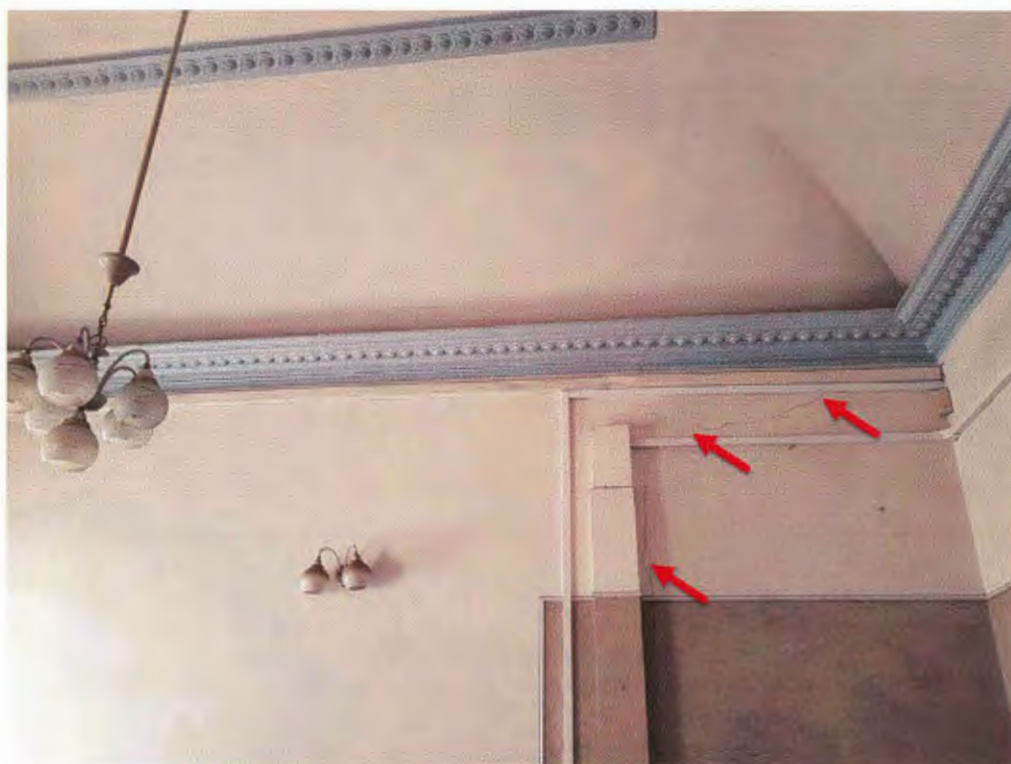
Сквозная трещина (отмечена стрелками) в месте примыкания деревянной перегородки к кирпичной стене по оси «4»
